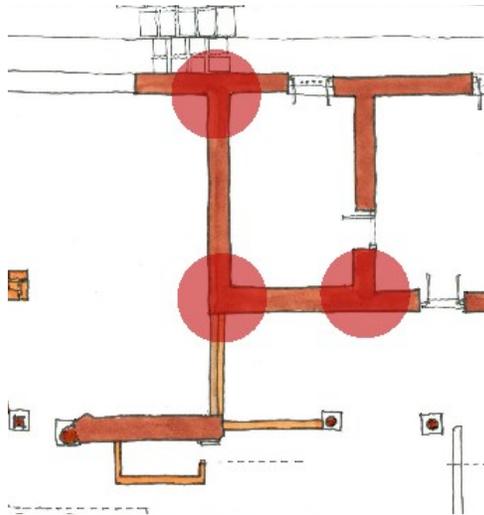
Esquinas sólidas en muros de tapia pisada, caso 14.
